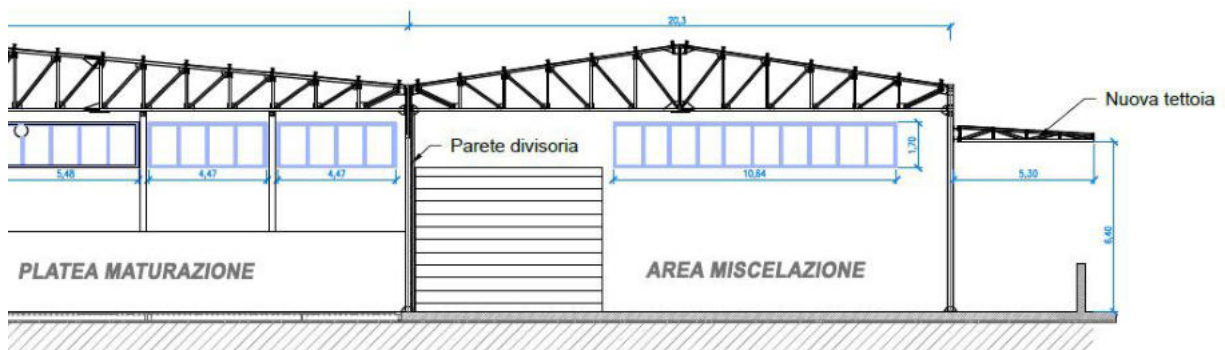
DETTAGLIO della SEZIONE – COLLOCAZIONE del MURO DI SEPARAZIONE
